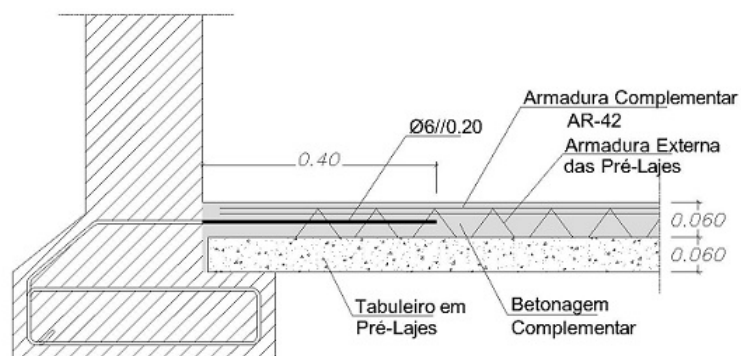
Pormenor de selagem da laje na viga pré-fabricada [18]
